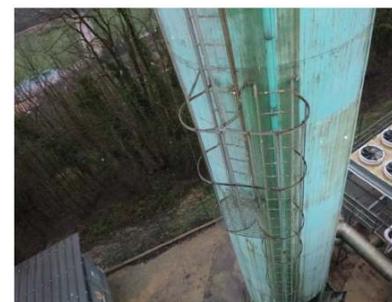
et 9 : Face externe en partie basse – vieillissement de protection vieillissant
